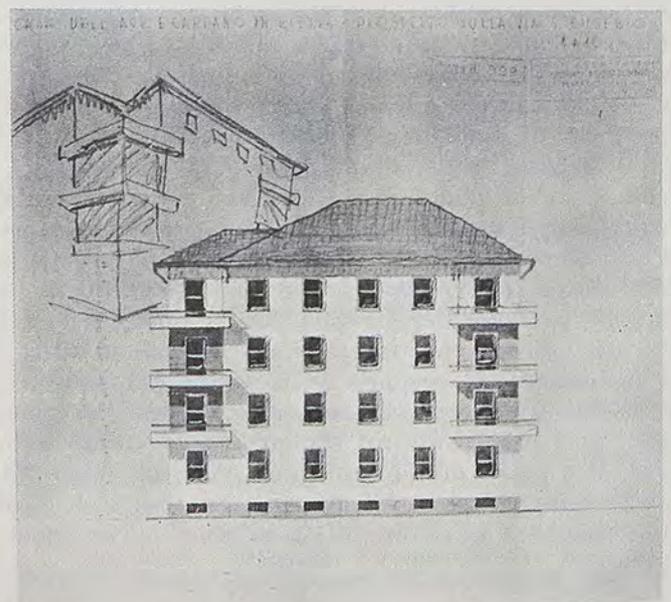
b - Casa Carpano: prospetto su via S. Eusebio con schizzo prospettico a matita.
